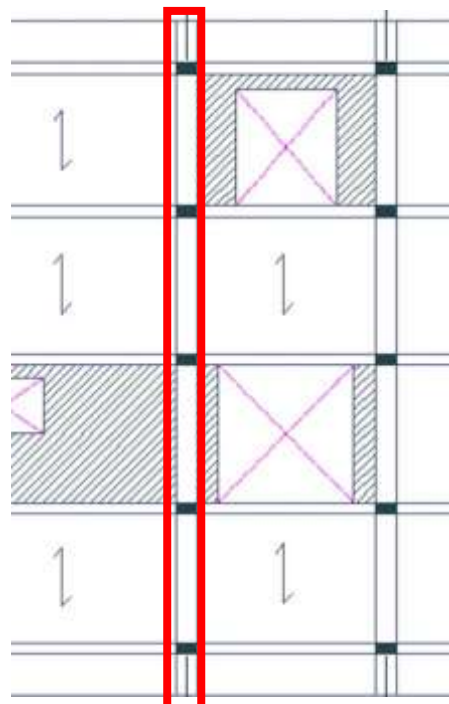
Planta del nivel 4 indicando viga chata V-6 y viga peraltada V-28.
